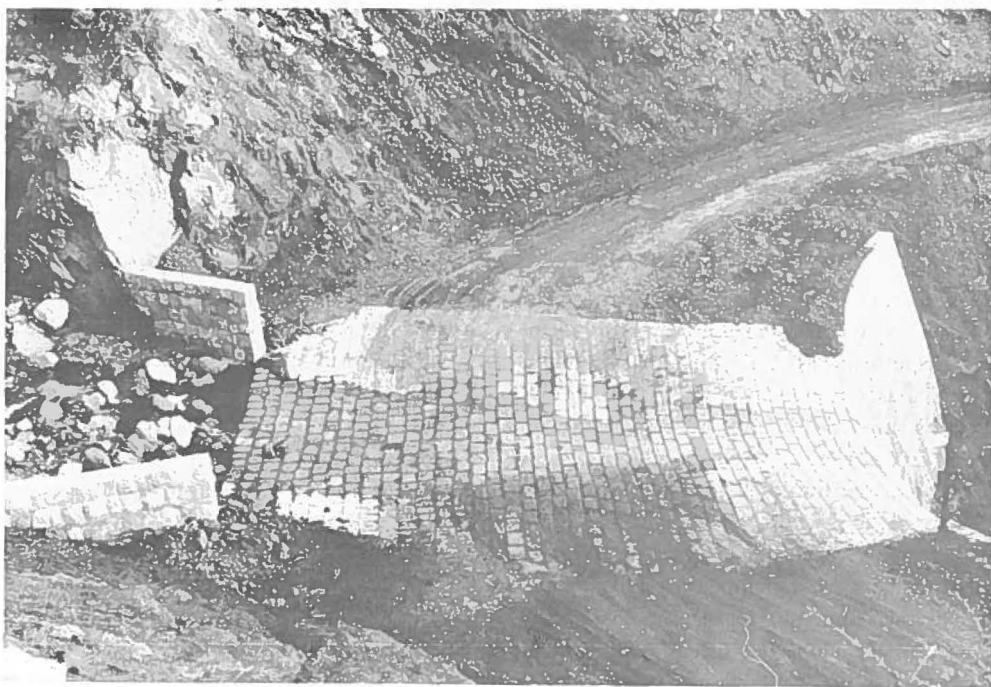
Badeñ de mampostería en camino de acceso a Central Hidroeléctrica "Los Maitenes", Quebrada Seca. (Sitio N de Fig. 2.)
